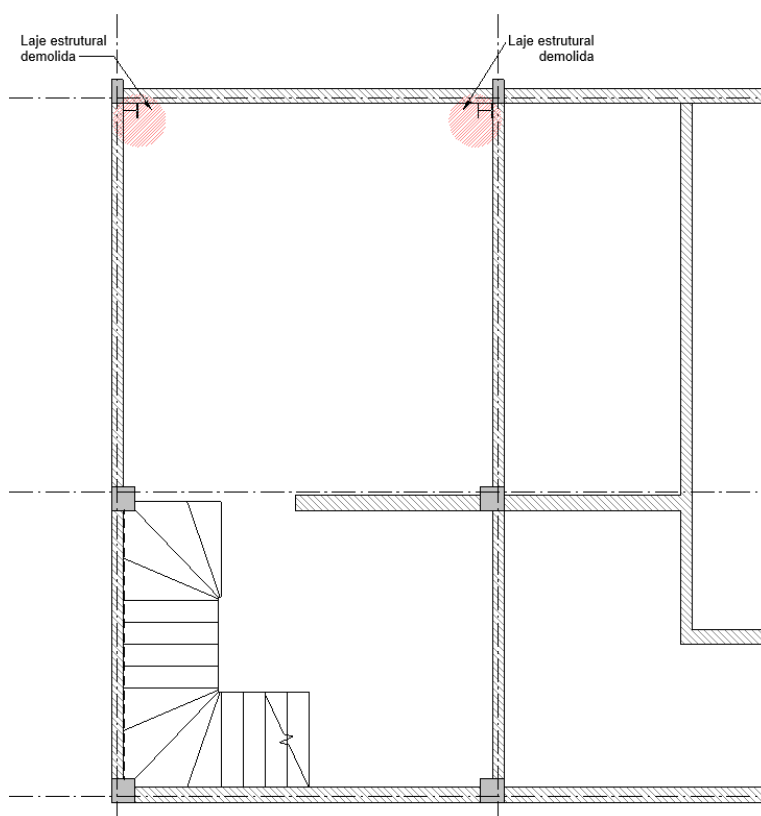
Área de demolição o piso do banheiro para executar as fundações
